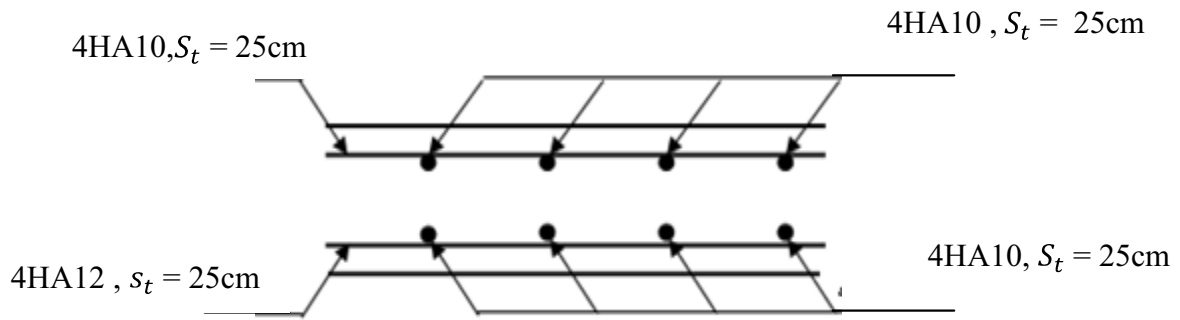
vue en coupe du ferrailage de la dalle de l'ascenseur
